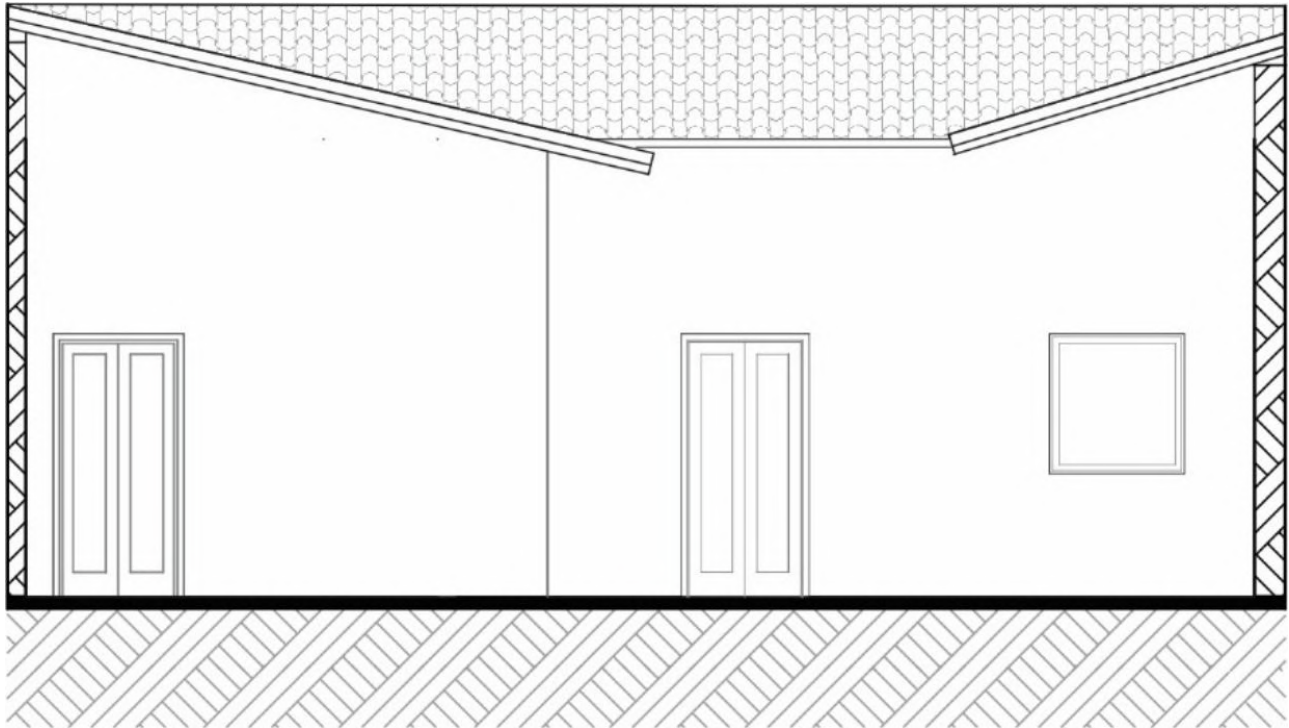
Plano Fachada A02- Fachada posterior – Occidental - Cuerpo Secundario
